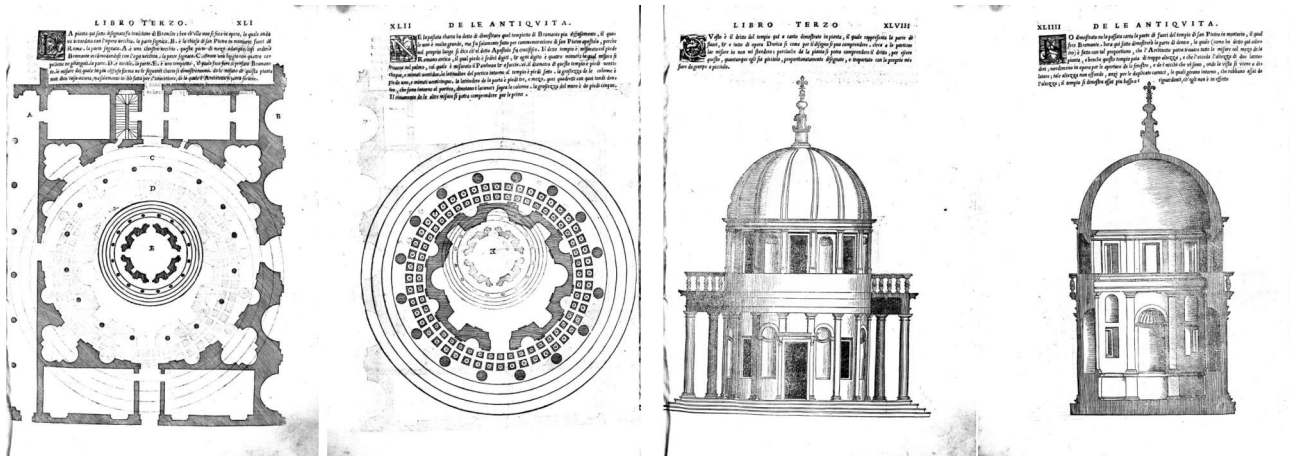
Architekturdarstellung bei Serlio. Der Tempietto von Bramante in Lageplan, Grundriss, Ansicht und Schnitt. Quelle: Serlio (1544): 41-44.
